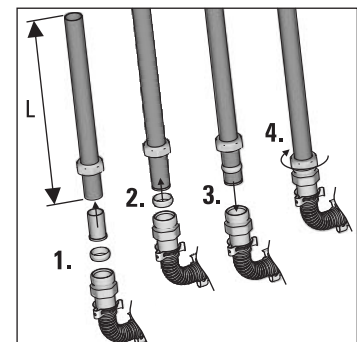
Verbindungsleitungen mit Anschlussfittings verbinden
